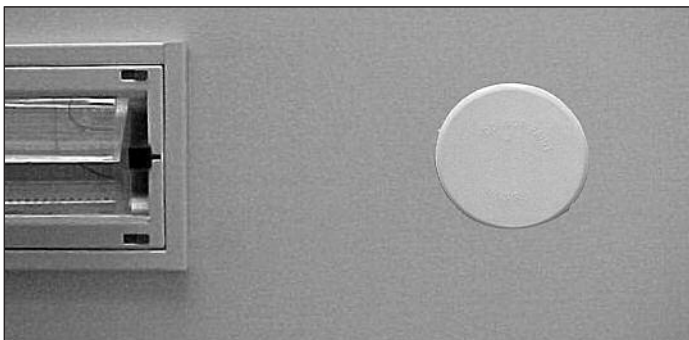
Afdekkapje van WIRSBO sprinklerkop
